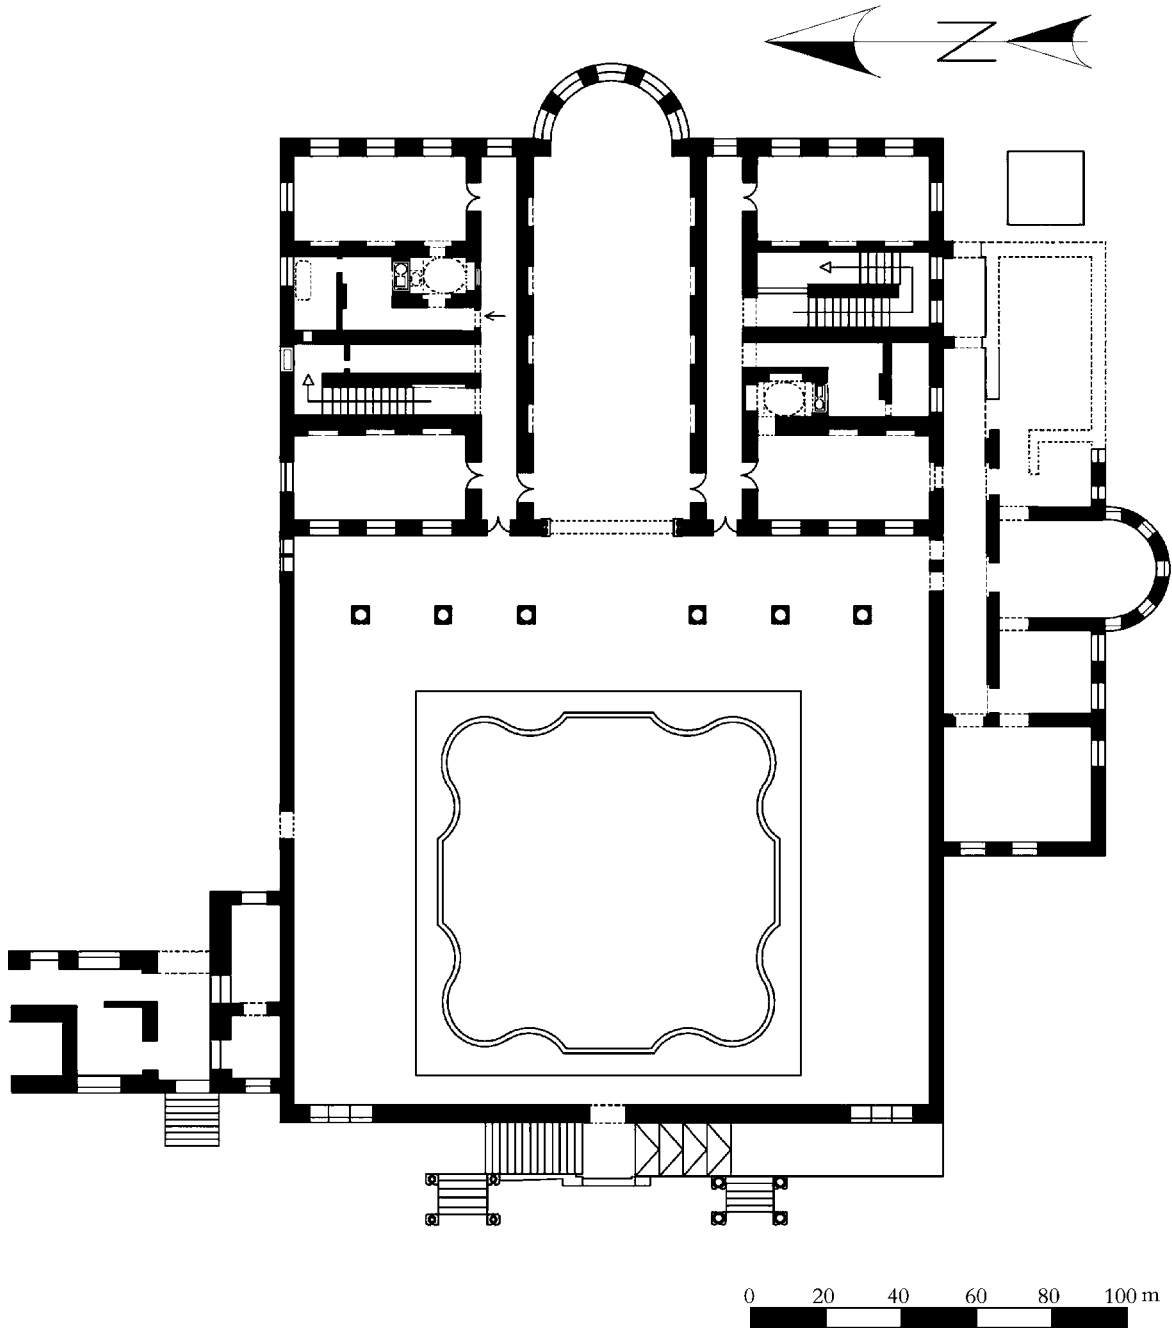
قصر بن سليمان بجبره: الطابق الأول، مسقط أفقي لوحدة الحمام الجنوبي.
